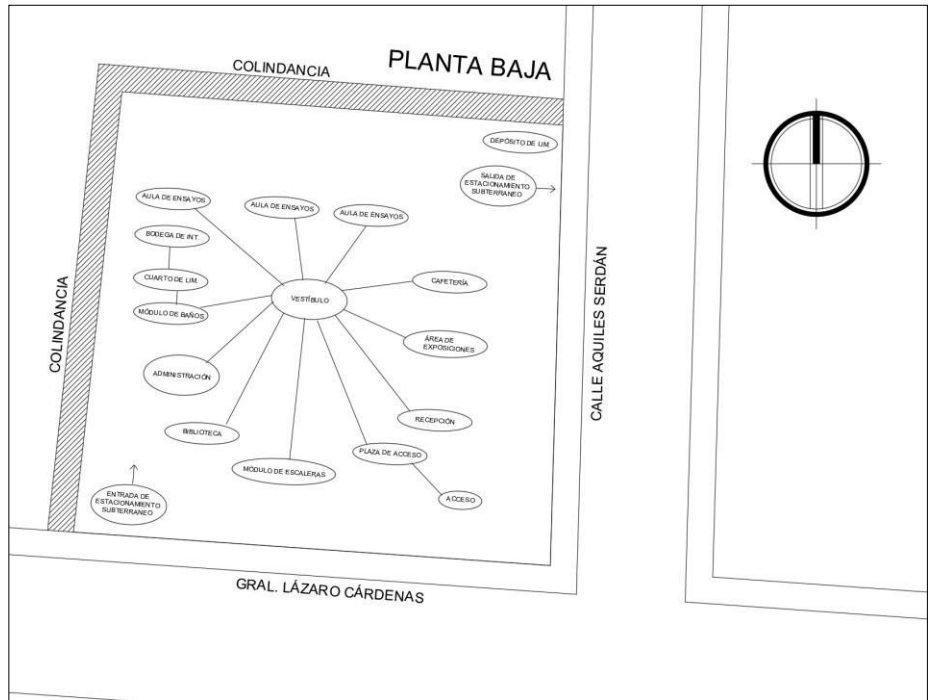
Primera Propuesta, Planta Baja. Propia 2021.
